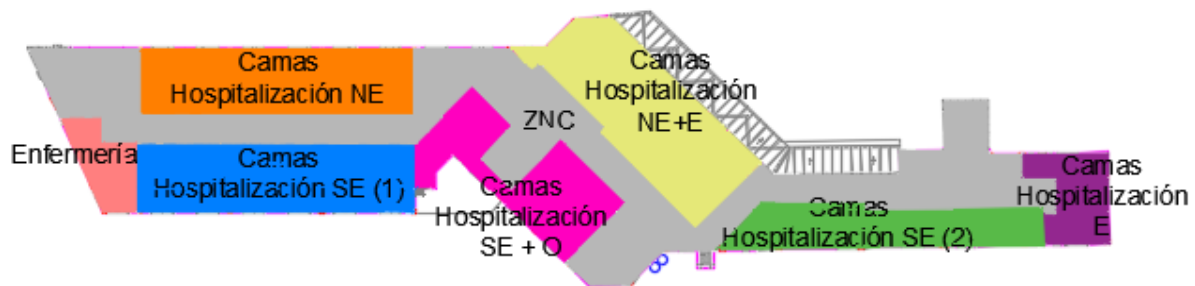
Anexo I. Zonificación planta 4 (fuente: elaboración propia).
